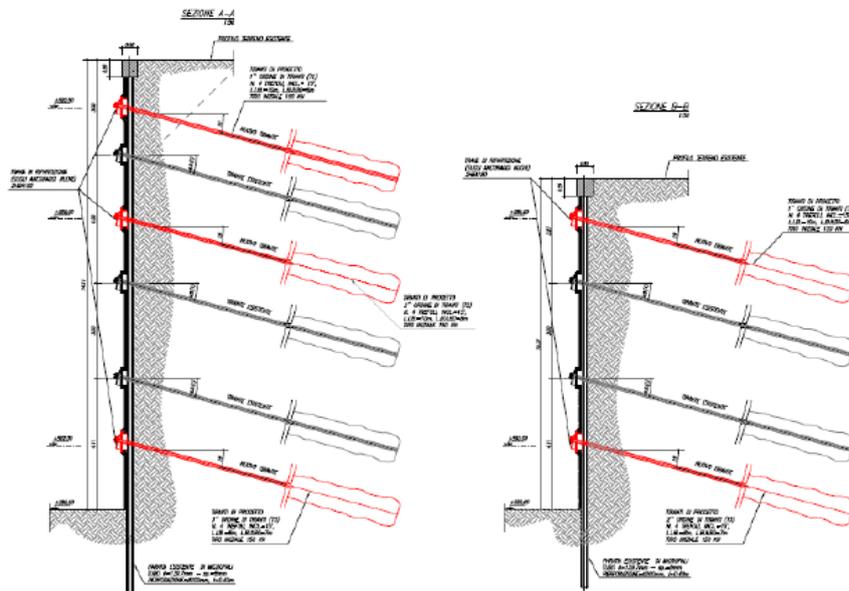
Galleria Guinza- Imbocco lato Umbria – Stato di progetto – Sezioni
